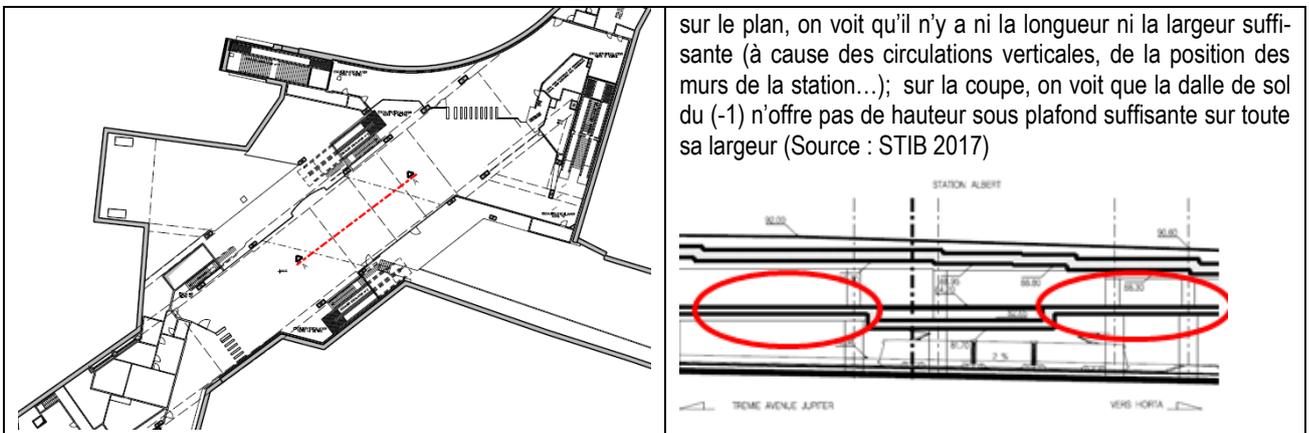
Plan du niv.(-1) et coupe dans la station Albert (Source : STIB, 2017)
